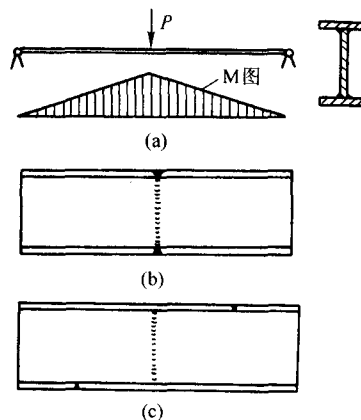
焊接工字梁对接焊缝的布置
